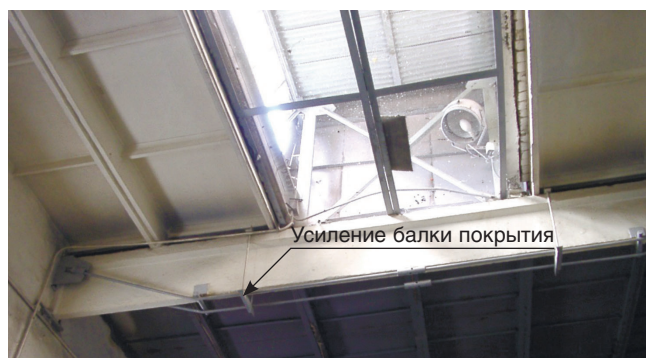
Крытие помещения (3) в пролете Г–Д, оси 4–7 (вид от ряда Д)
